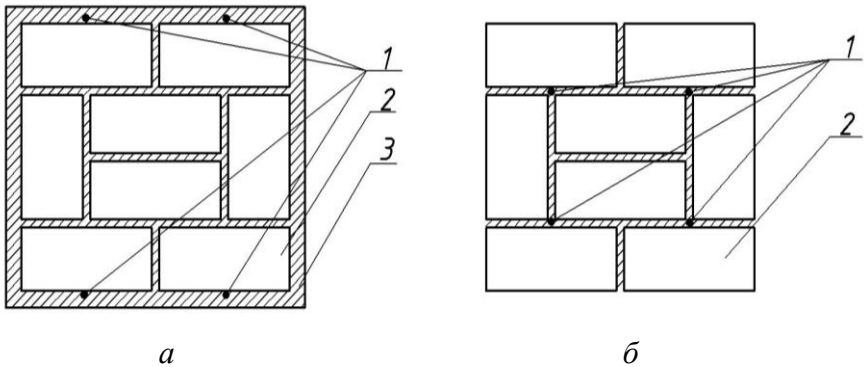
Поздовжнє армування кладки: *a* – зовнішнє; *б* – внутрішнє: 1 – арматурний стержень; 2 – цегла; 3 – захисний шар
